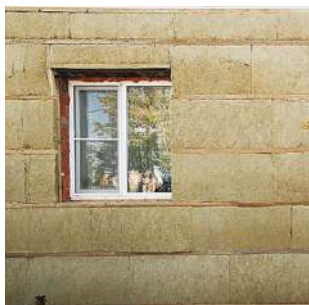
Монтаж теплоизоляционных плит в горизонтальный каркас
